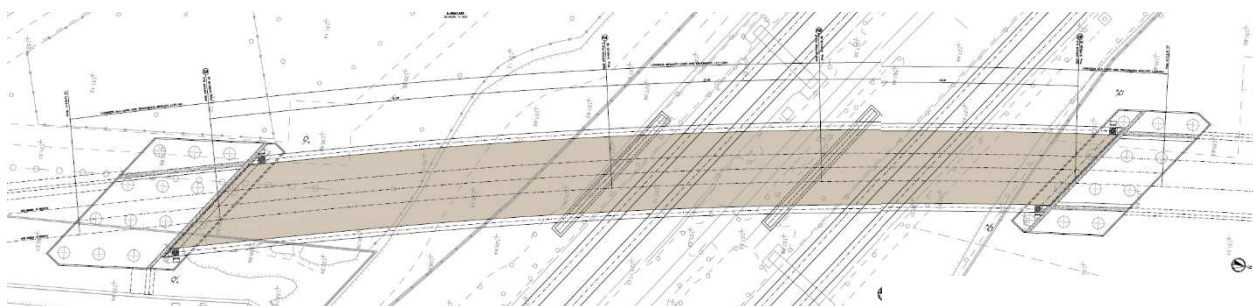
Pianta manufatto di scavalco su linea RFI.
